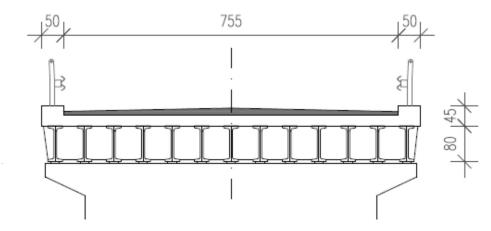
SEZIONE TIPICA IMPALCATO
